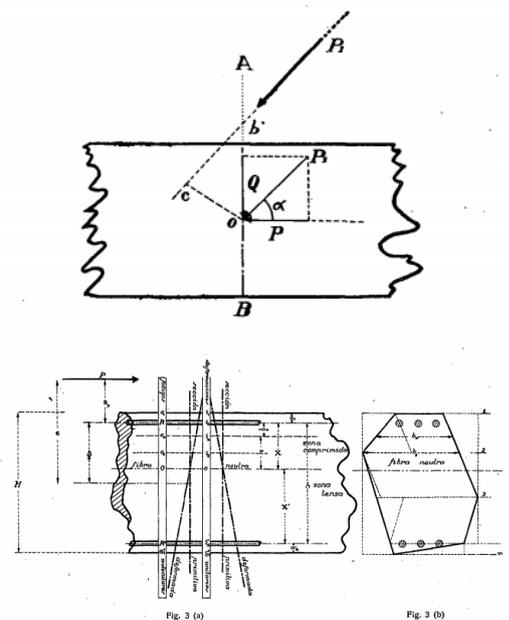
Dibujos explicativos de la teoría de la flexión (García, 1935)
